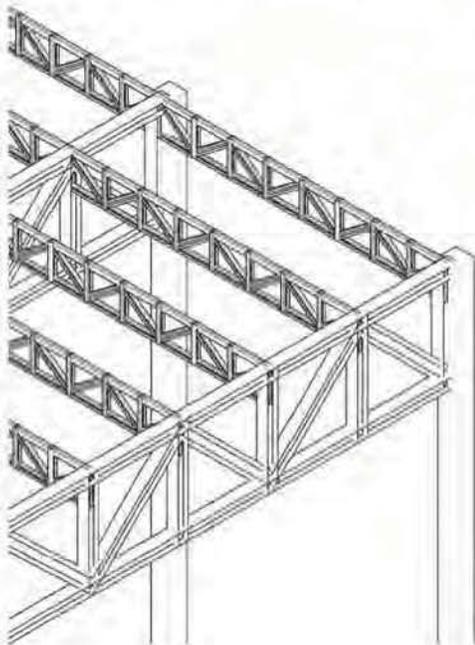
Armadura principal en ejes principales en la sala de conciertos a base de perfiles ptr y largueros para recibir multytecho. Armaduras ancladas a columnas que van hasta la cimentación.
